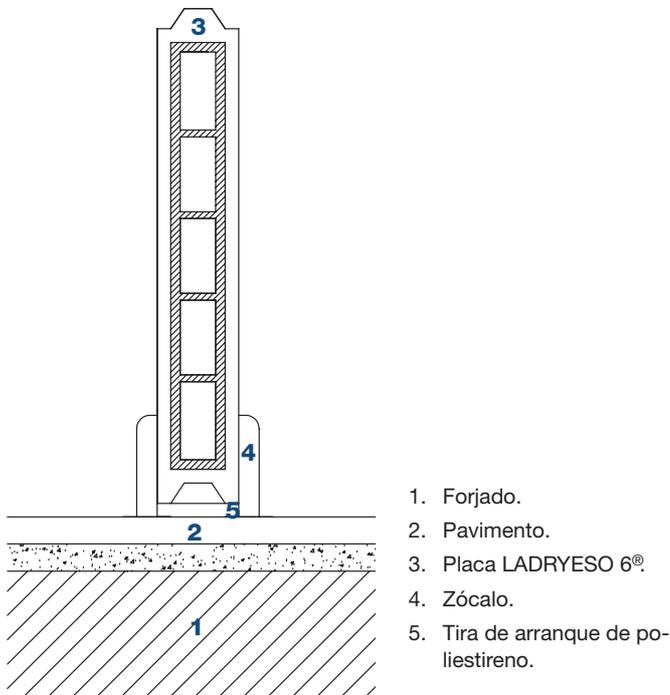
Colocación del tabique LADRYESO 6® sobre pavimento.
